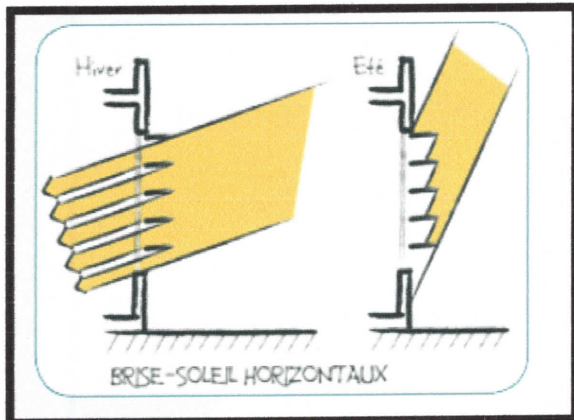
Brise-soleil horizontaux intérieur, source: (Groupe de travail de l'ICEB 2014)
